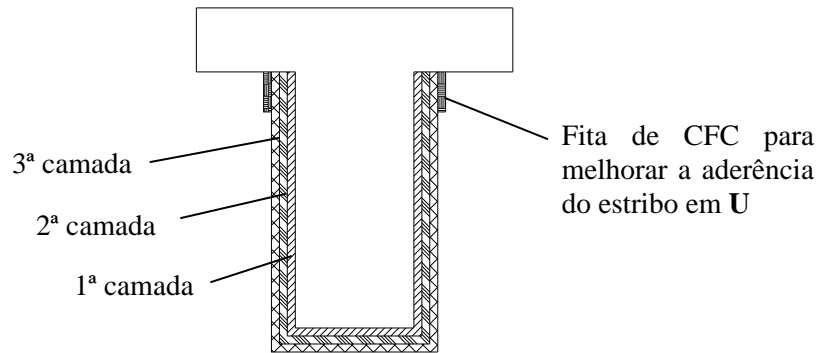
Seção transversal AA' das vigas reforçadas VI-3 e VII-3.
